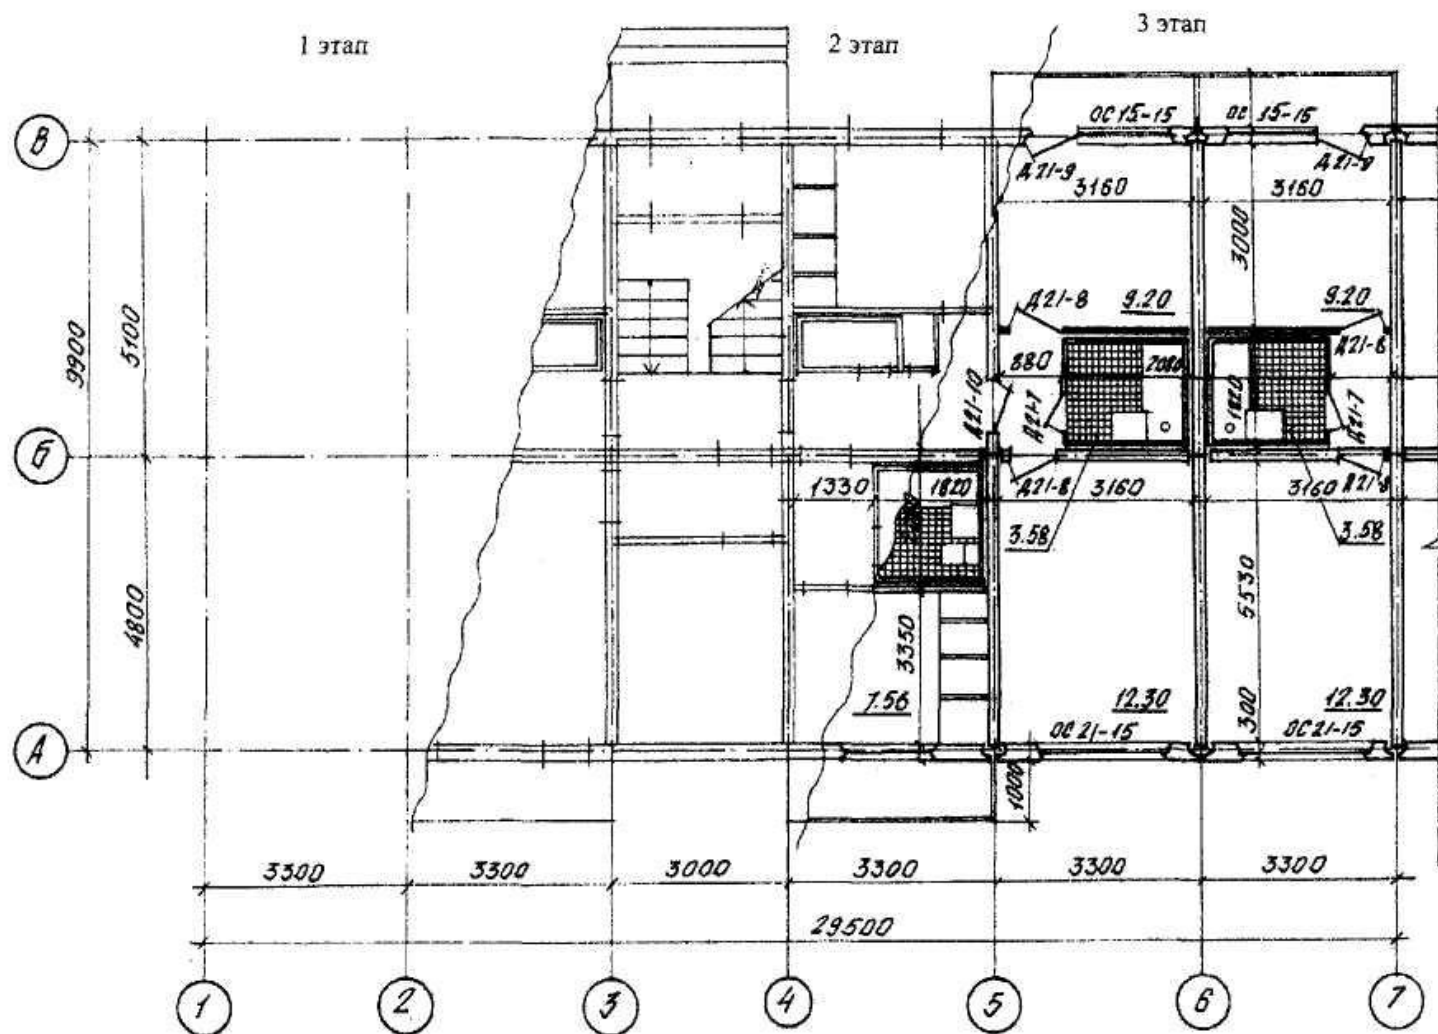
Этапы выполнения плана первого этажа жилого дома
